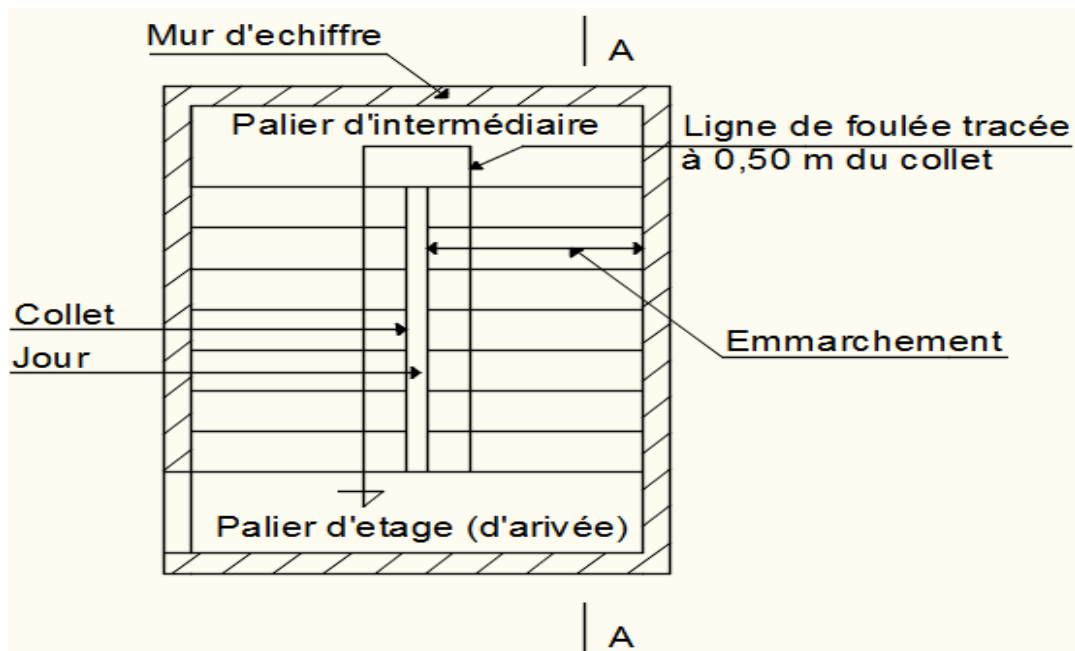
Vue en plan de la cage d'escaliers.
